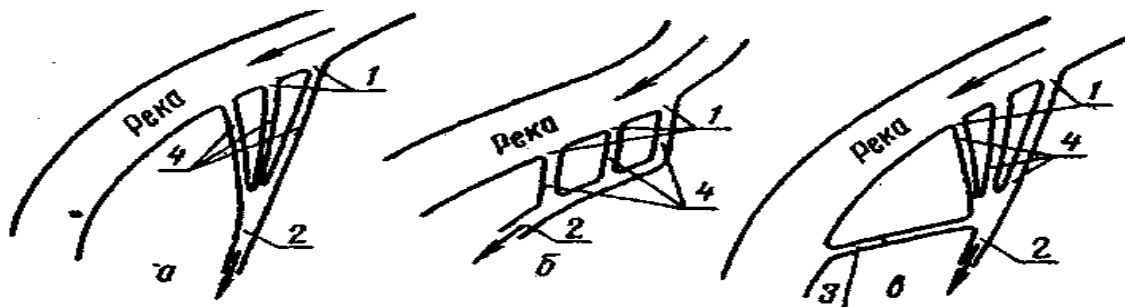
Многоголовые нерегулируемые водозаборы:
